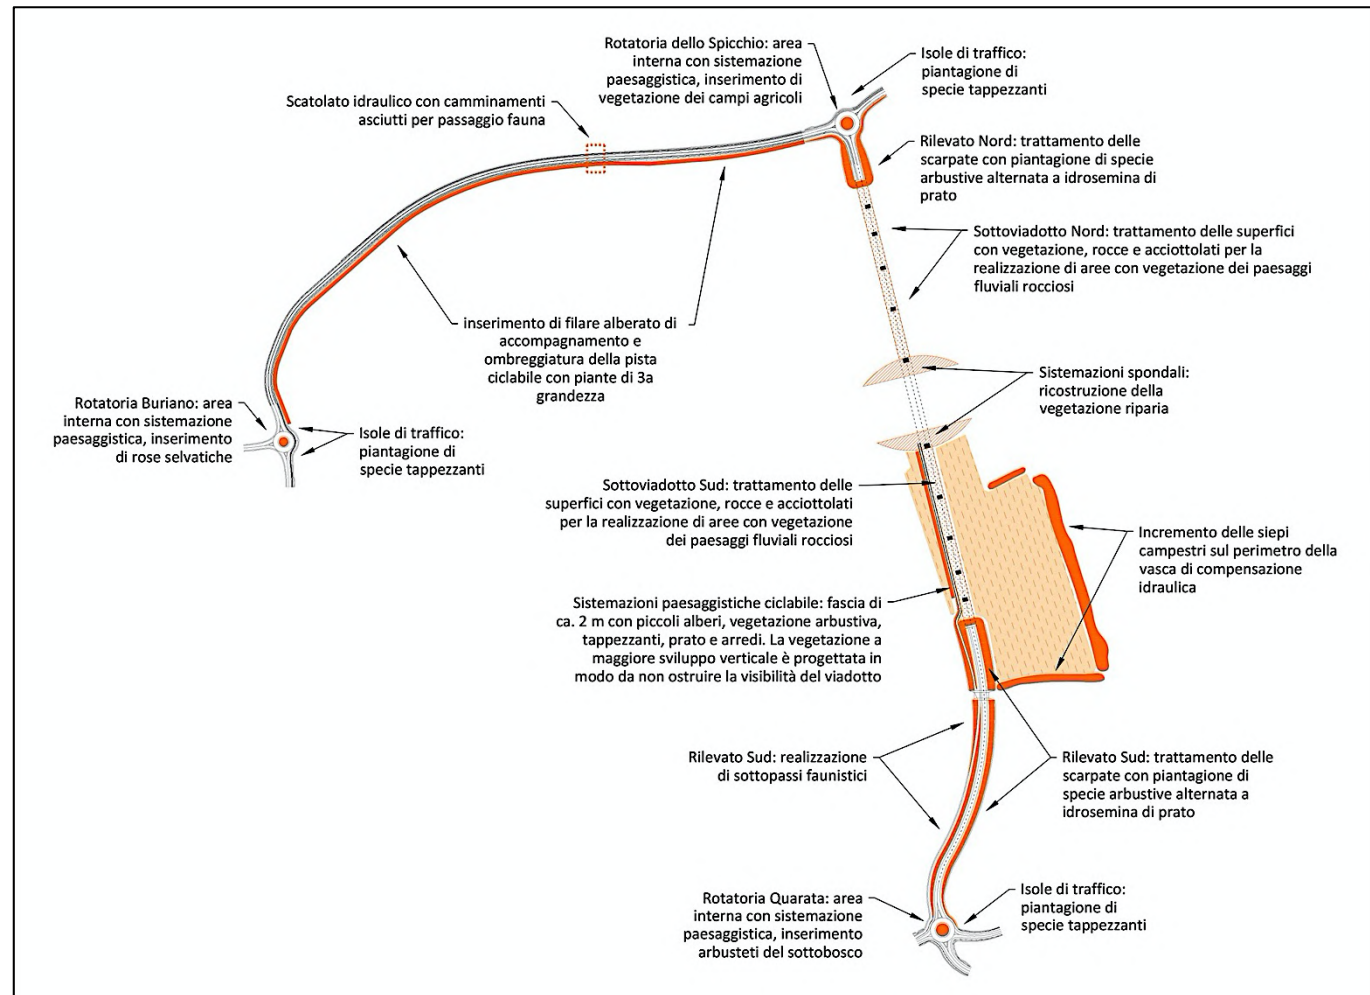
Planimetria con l'individuazione degli interventi paesaggistici
